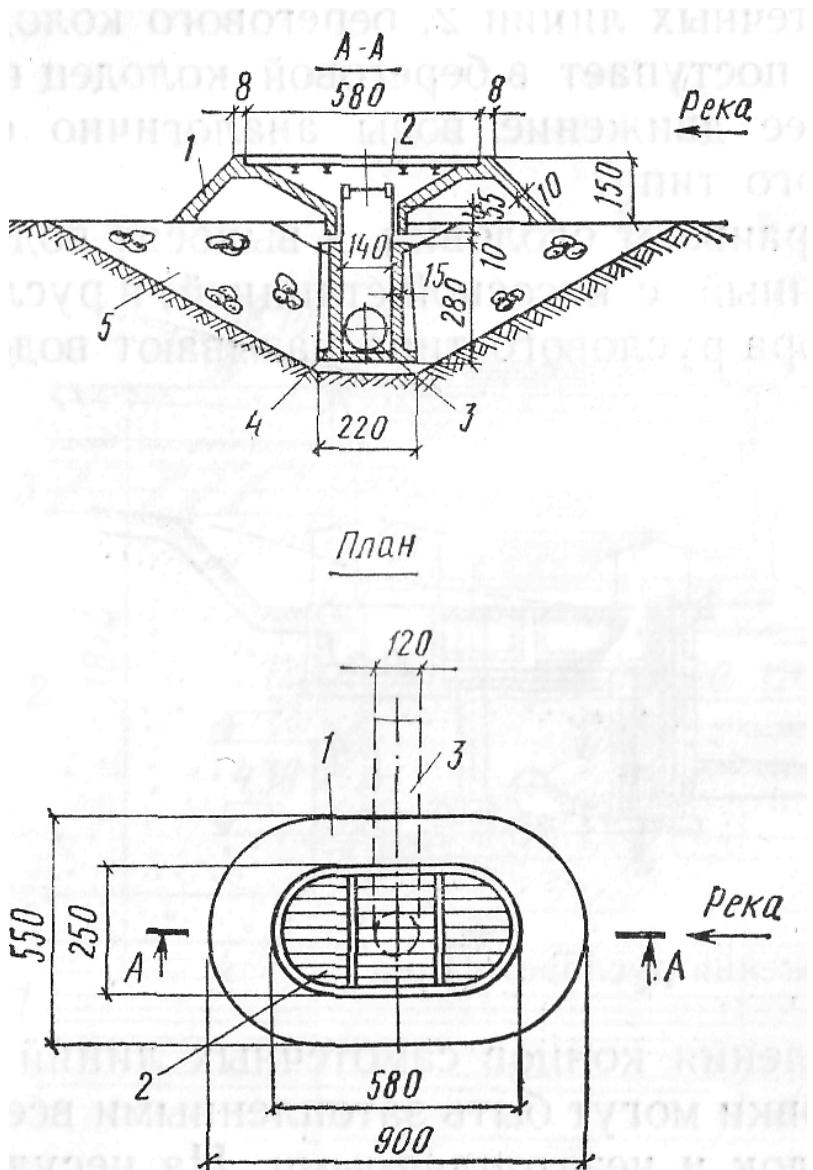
Железобетонный оголовок с горизонтальной решеткой (размеры в см)
